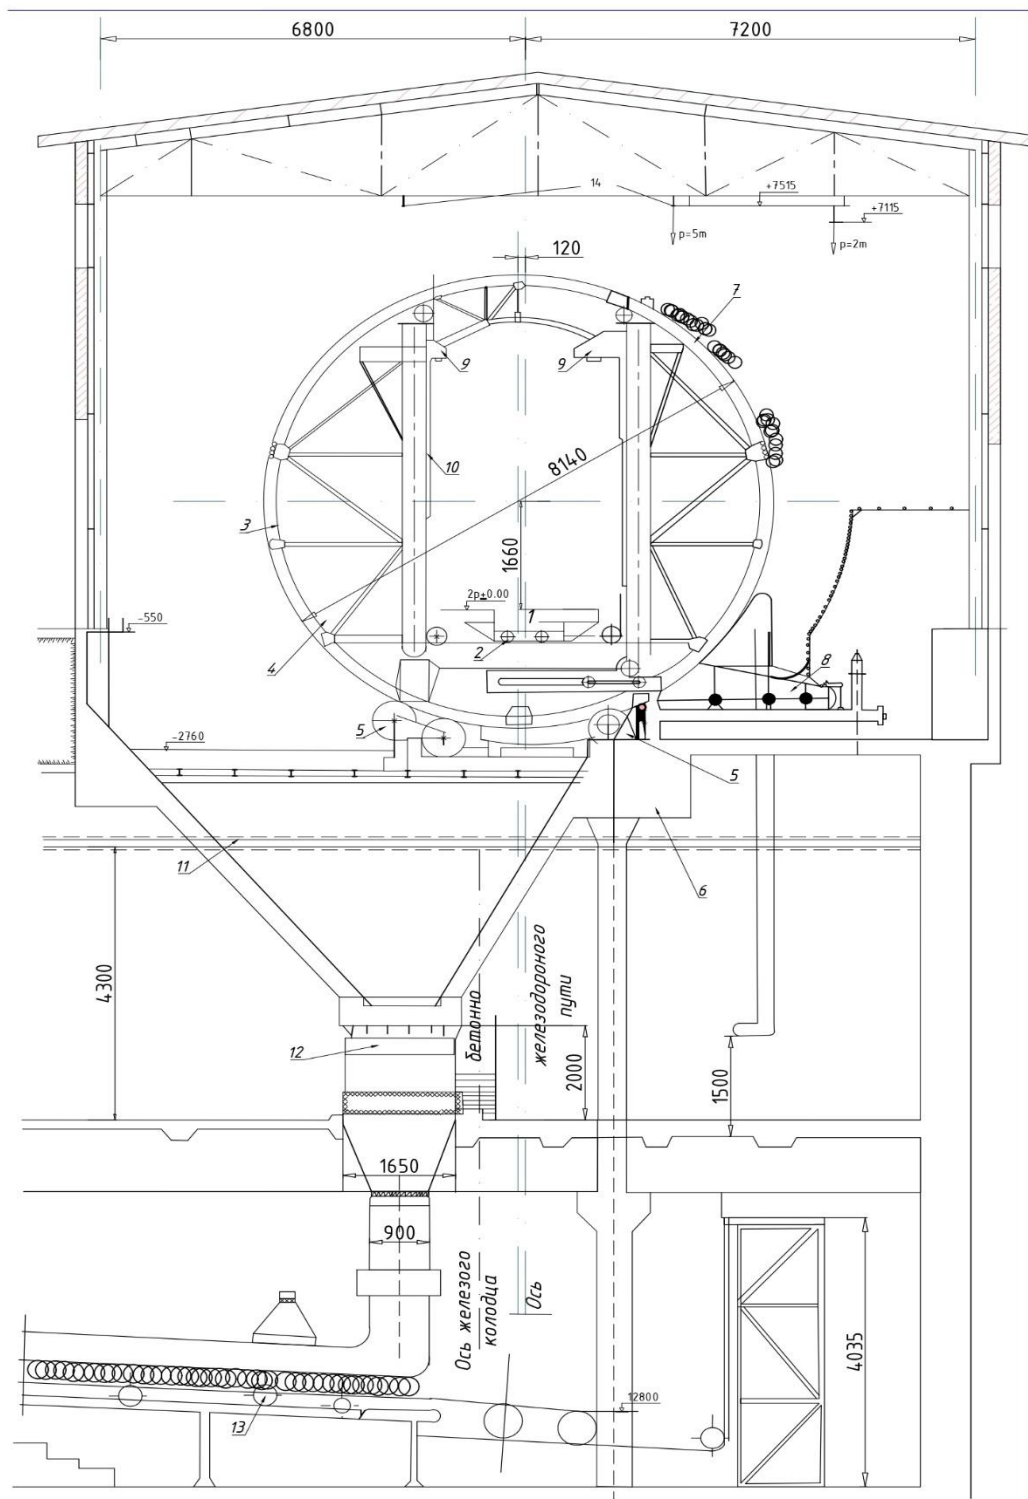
Схема роторного вагоноопрокидывателя типа ВРДС-100Л
